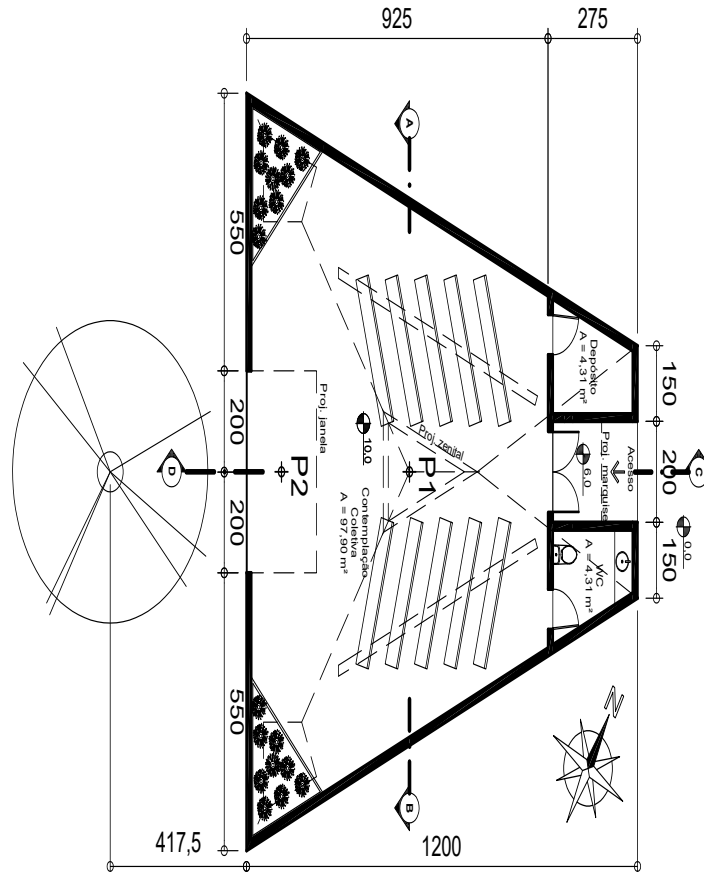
Planta baixa da edificação proposta. Fonte: Elaborado pelos autores.
